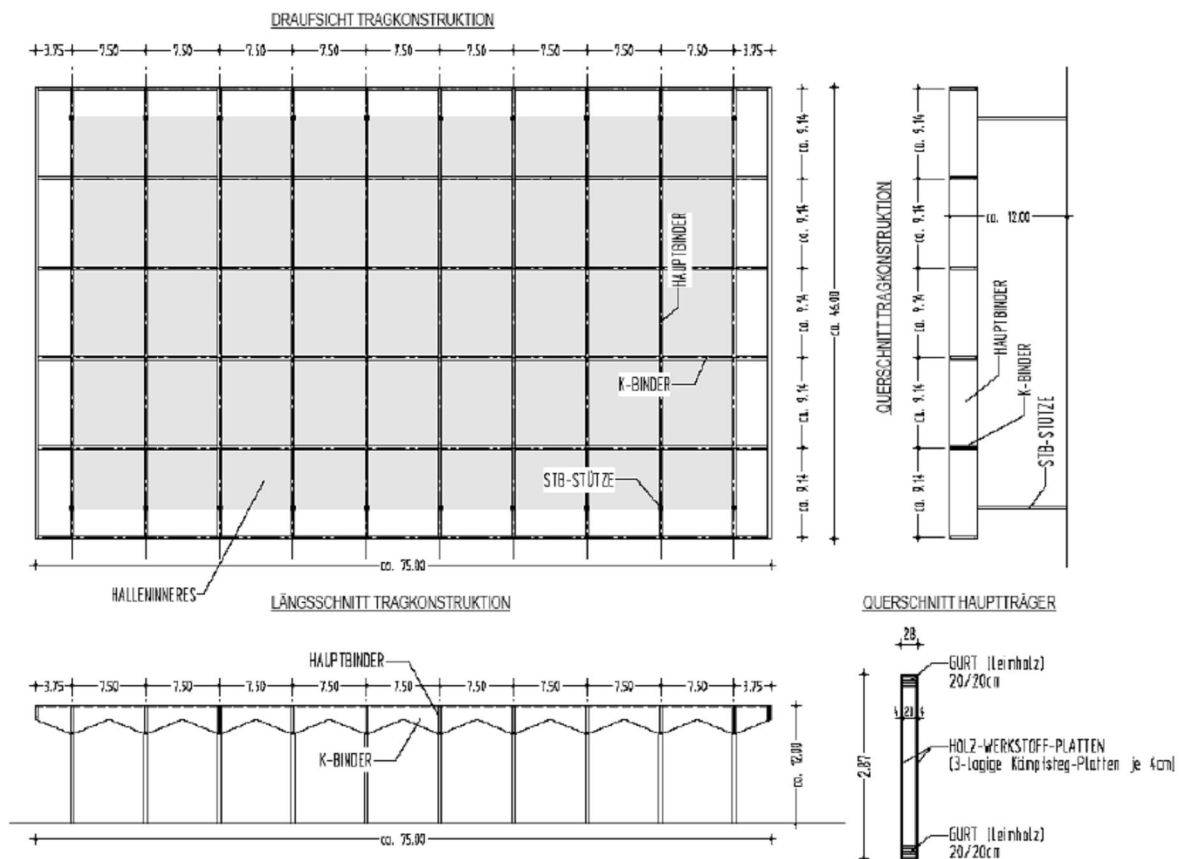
System des Dachtragwerkes in Draufsicht und Querschnitt
